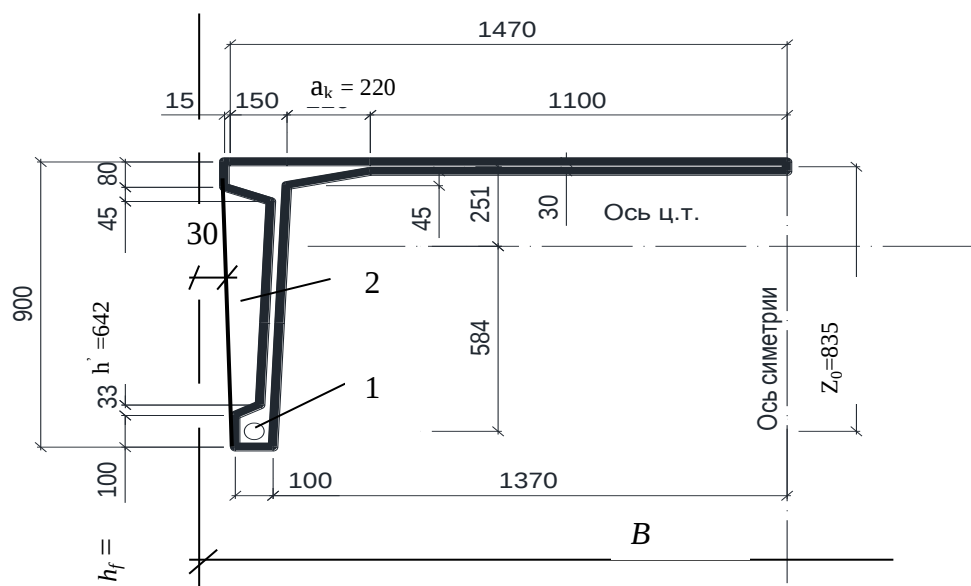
Поперечное сечение панели-оболочки КЖС: 1 – напрягаемая арматура; 2 – вертикальное ребро жесткости
